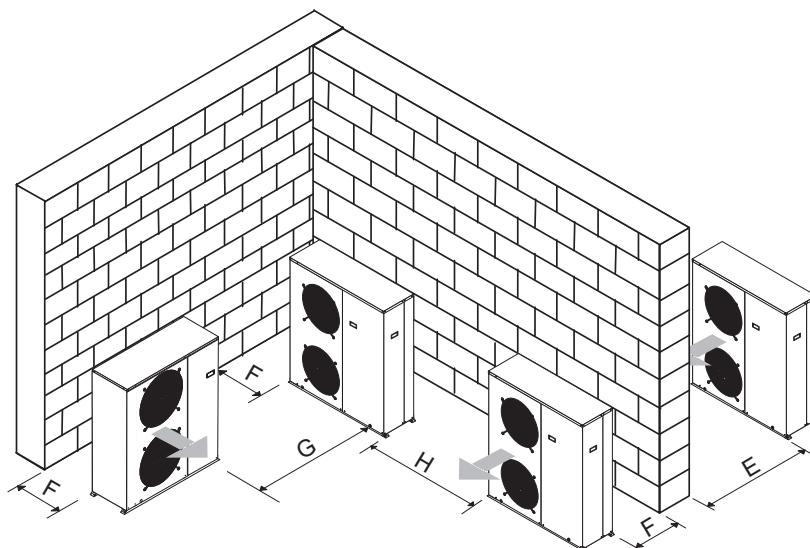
spazi di rispetto di unità installate rispetto ai muri.
